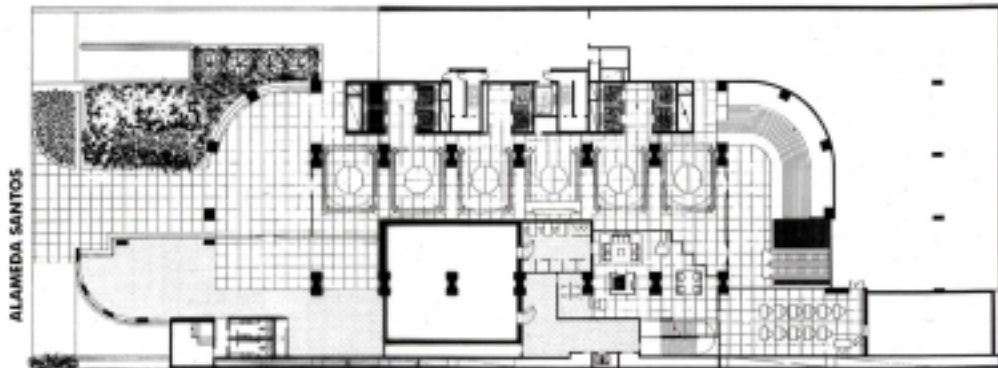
Planta pavimento térreo – Alameda Santos
